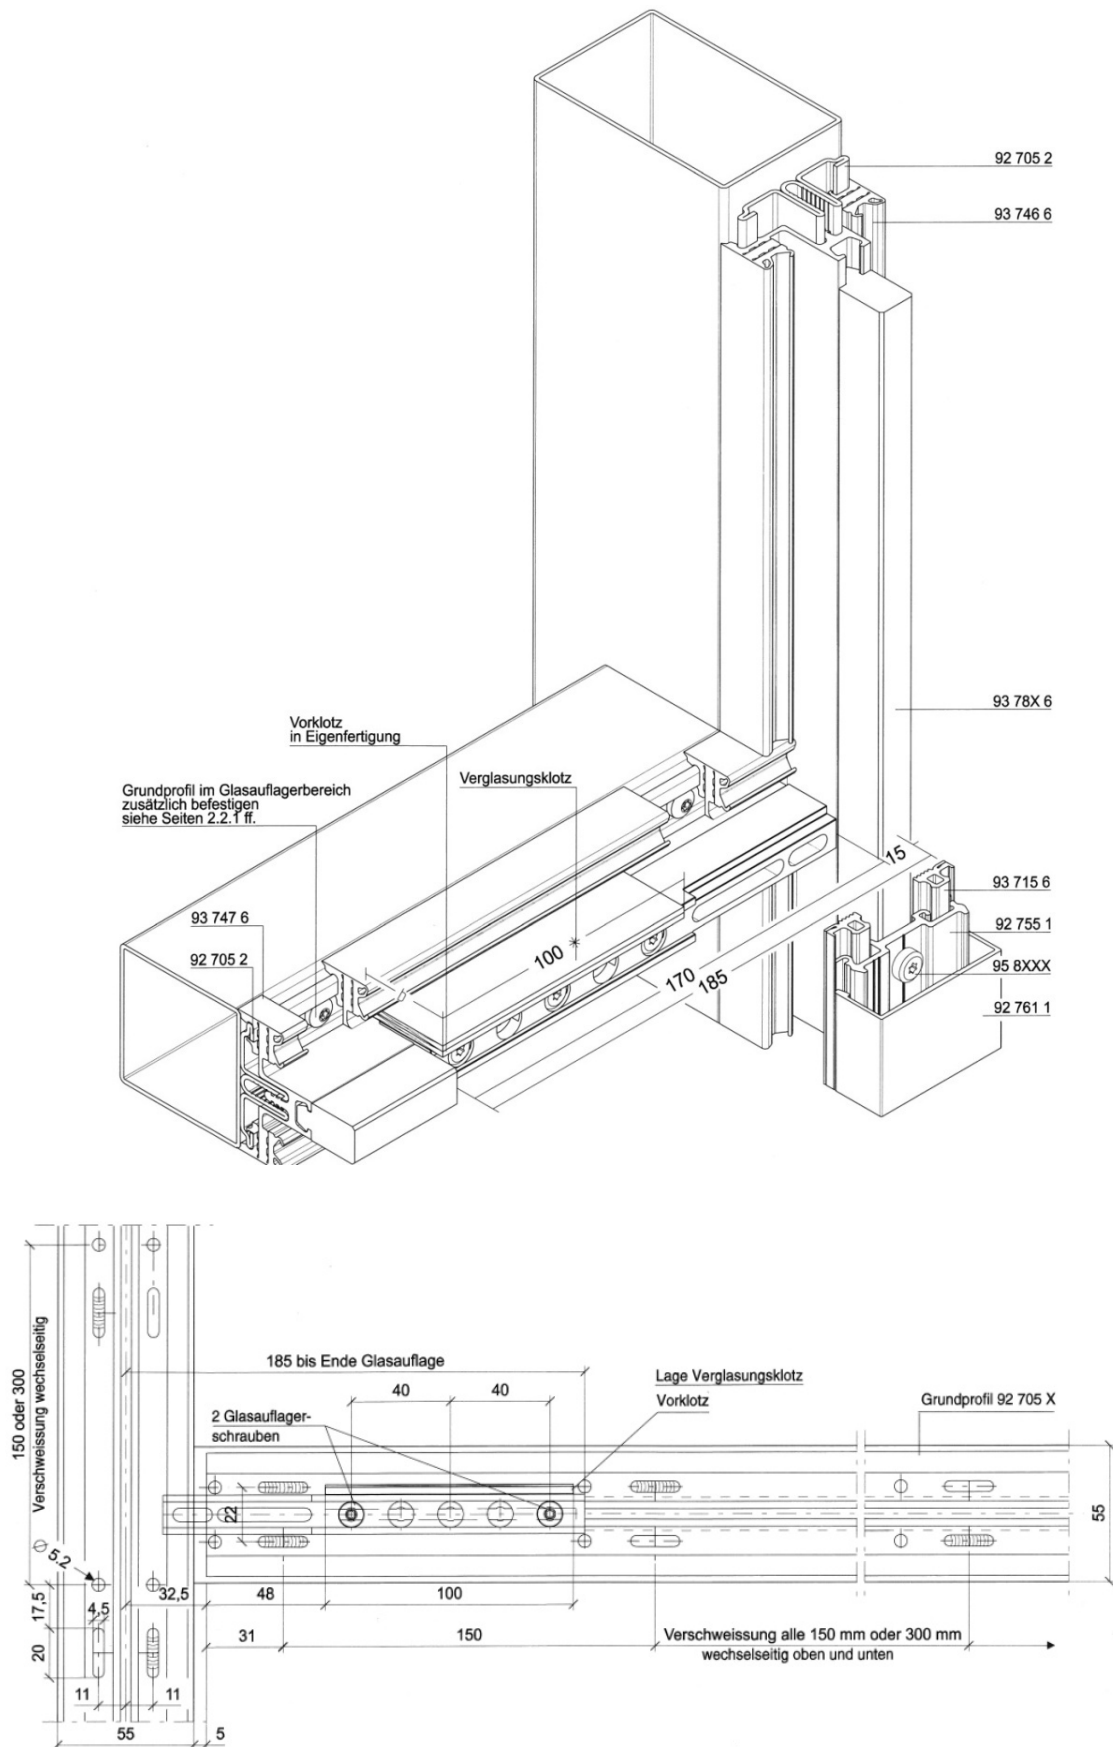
Grundprofil geschweißt mit geschraubtem Glasaufleger (2 Schrauben je Glasaufleger).
